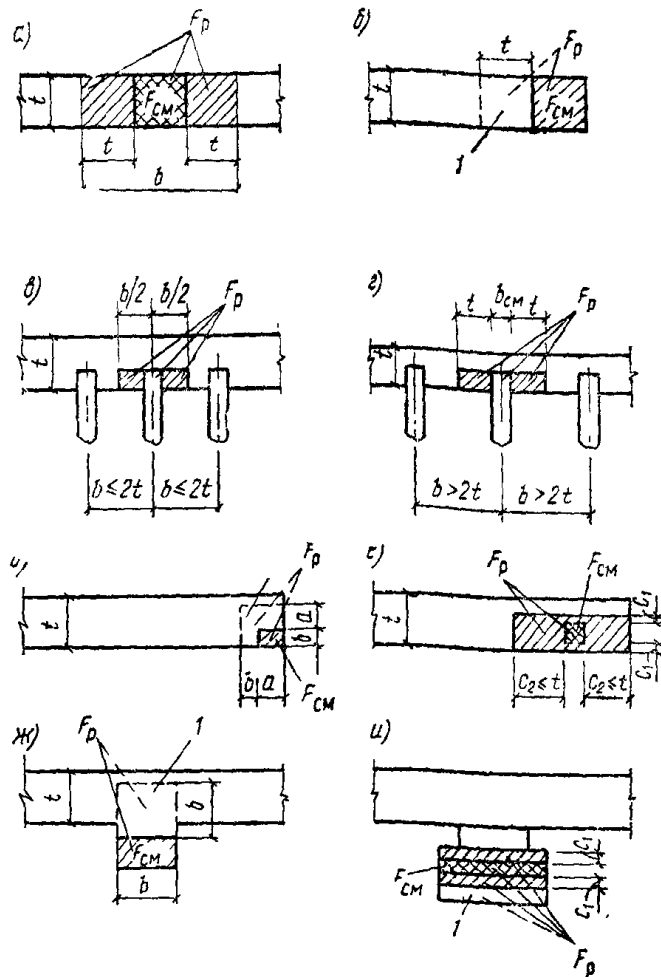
Определение расчетной площади F_p при расчете на местное сжатие
